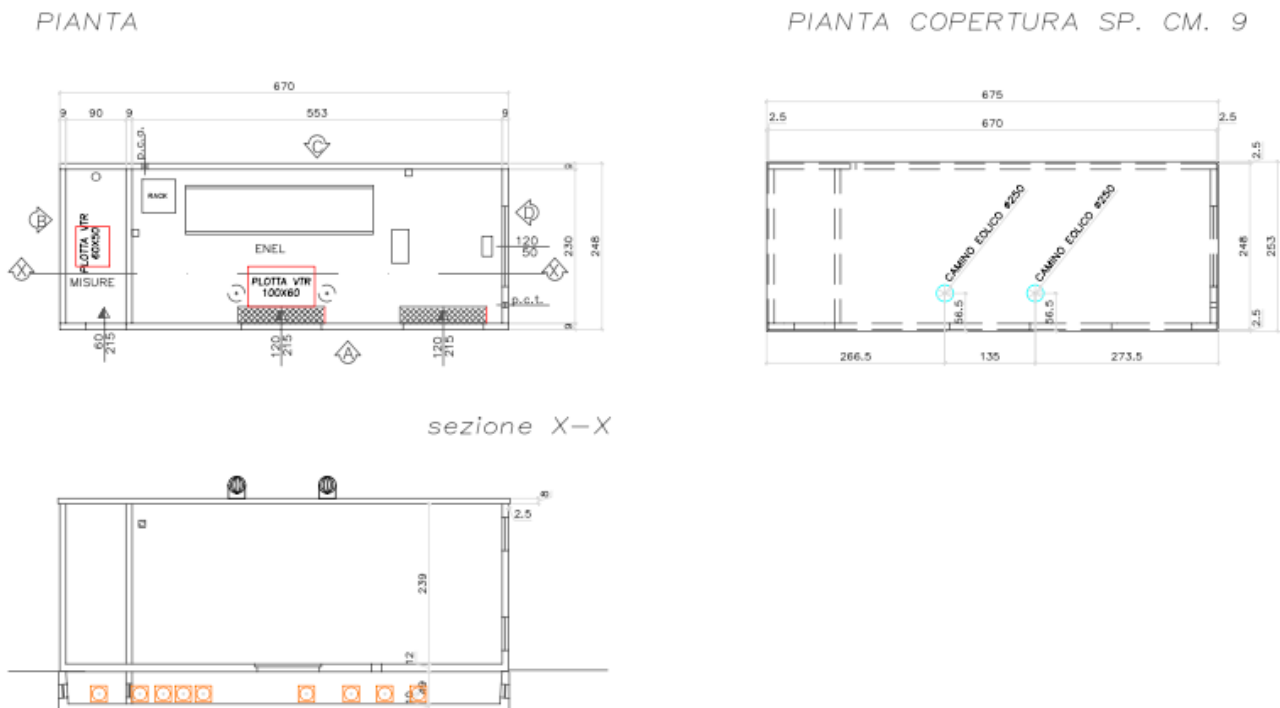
Pianta e prospetto del manufatto cabina di consegna MT (locale Distributore)
